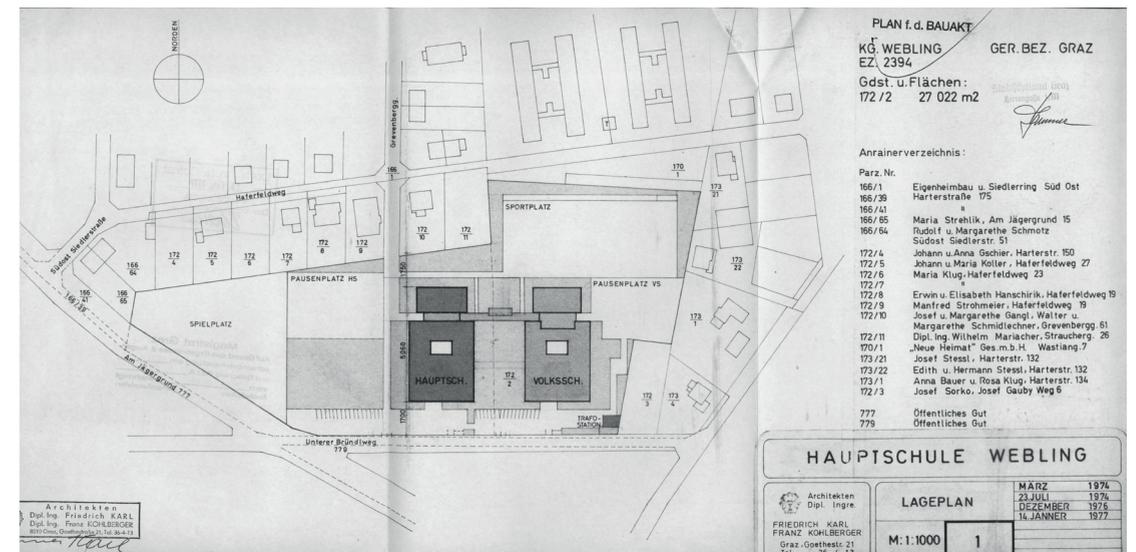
Lageplan, 1977 Stand Einreichplanung
